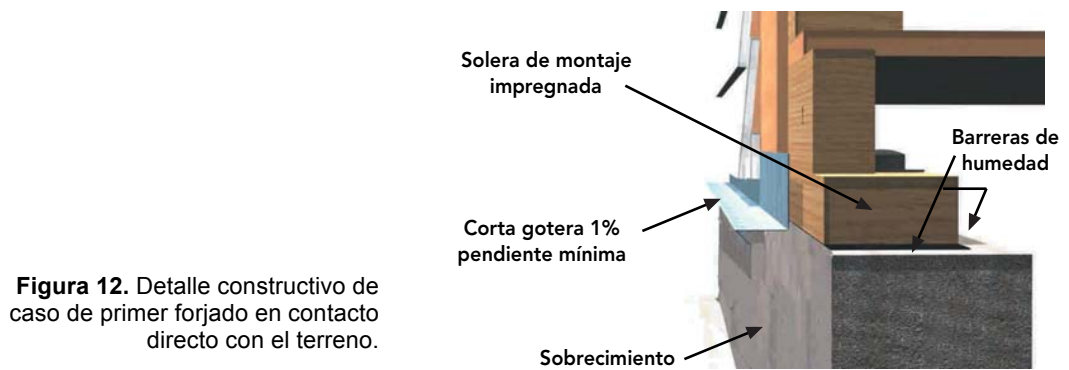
Detalle constructivo de caso de primer forjado en contacto directo con el terreno.
